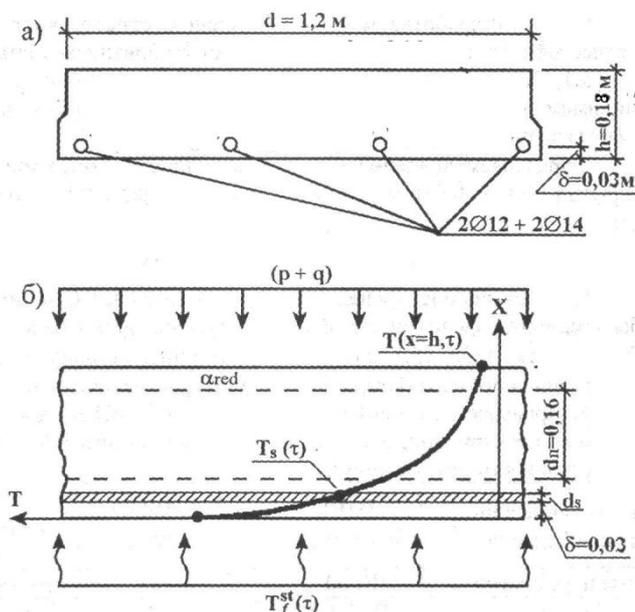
К расчету предела огнестойкости железобетонной, многпустотной плиты перекрытия а) поперечное сечение плиты; б) расчетная схема определения предела огнестойкости плиты.
